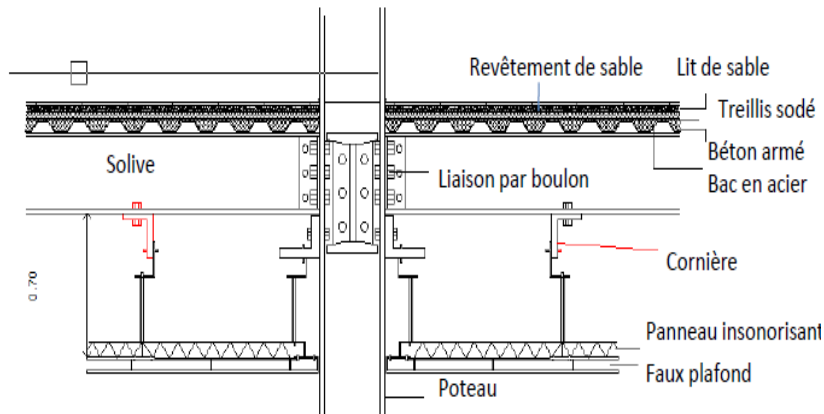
schéma de jonction poteau-plancher/ Source : les auteurs.
